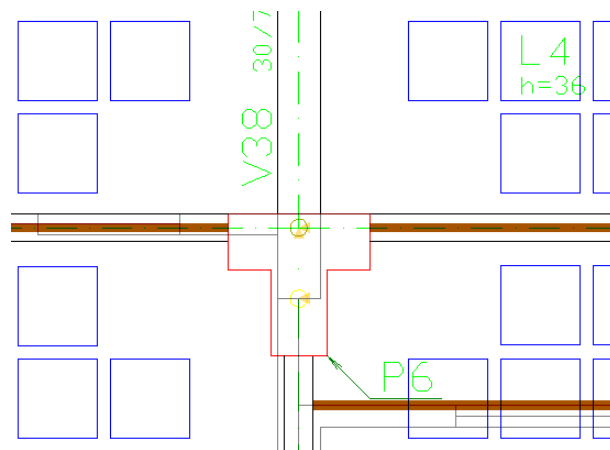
Região do Pilar P6 da Solução com Laje Nervurada
